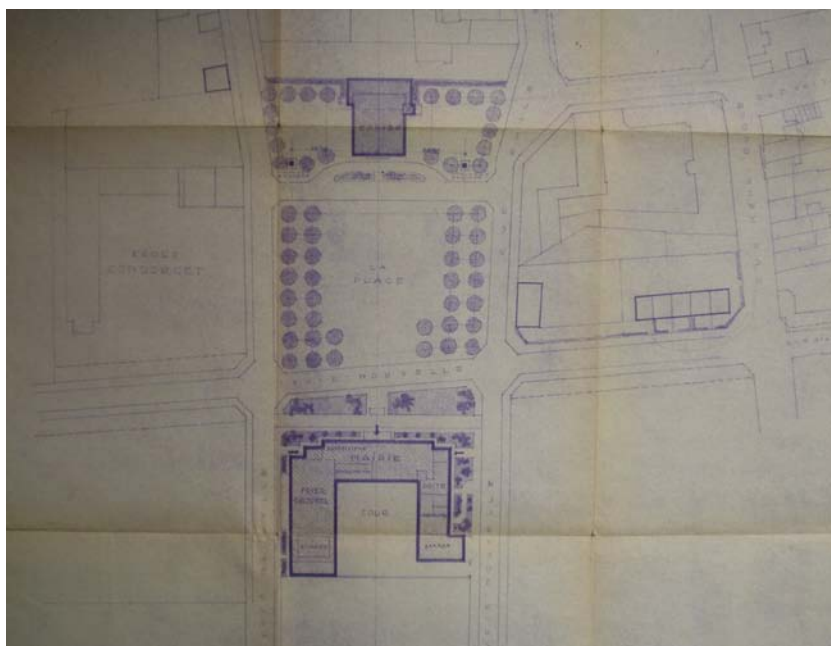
Plan masse 20-12-56 (AD Cambrai 7 L 2.352)
